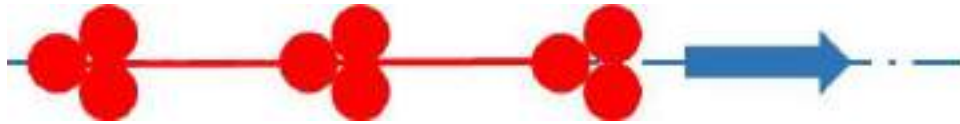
Reihenverankerung mit drei Stabgruppen (Grundriss).
